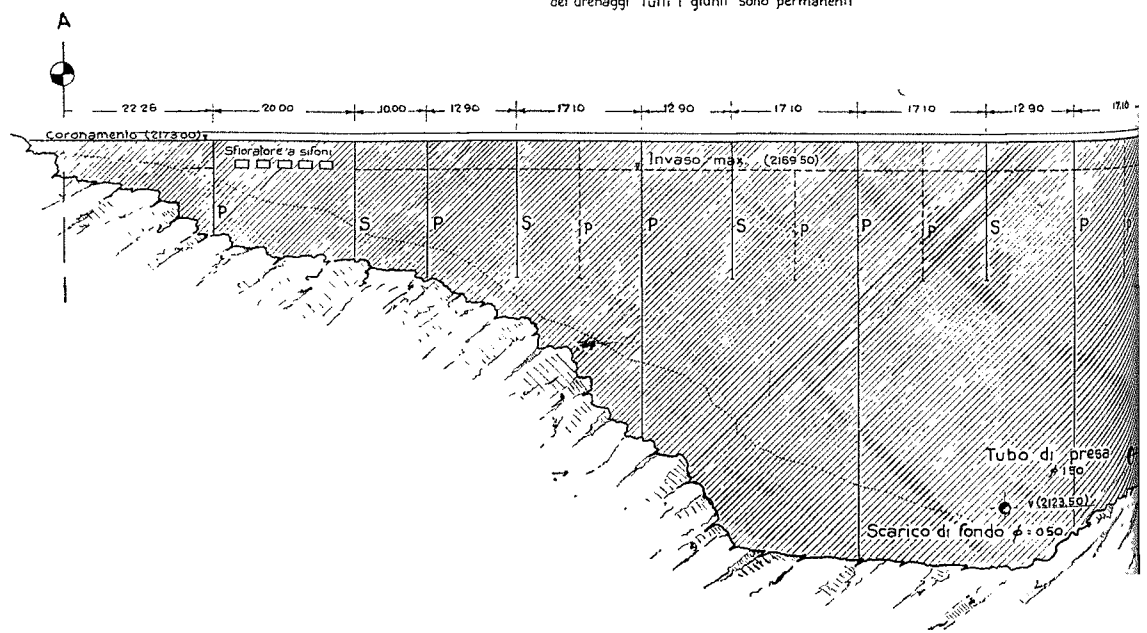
Vue d'ensemble du barrage de Cignana.
